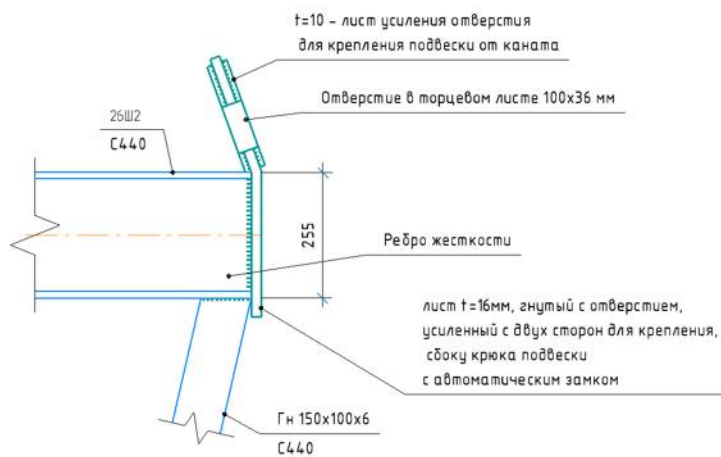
Узлы крепления подвесок от верхних поясов фермы
